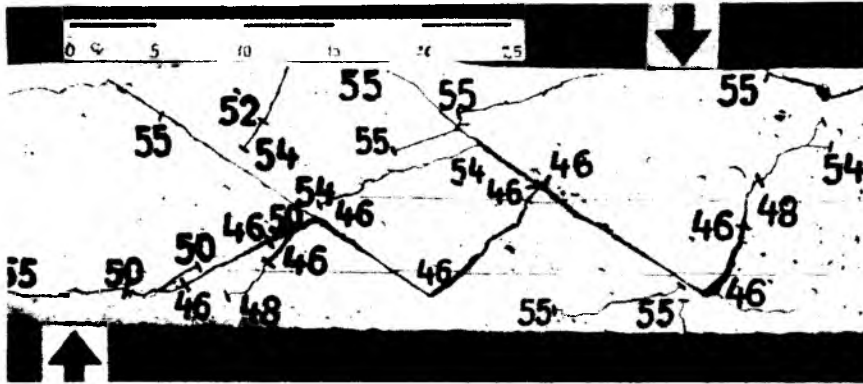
Образование и развитие трещин в балке Б-31 с двумя наклонными пластинами без поперечной арматуры
